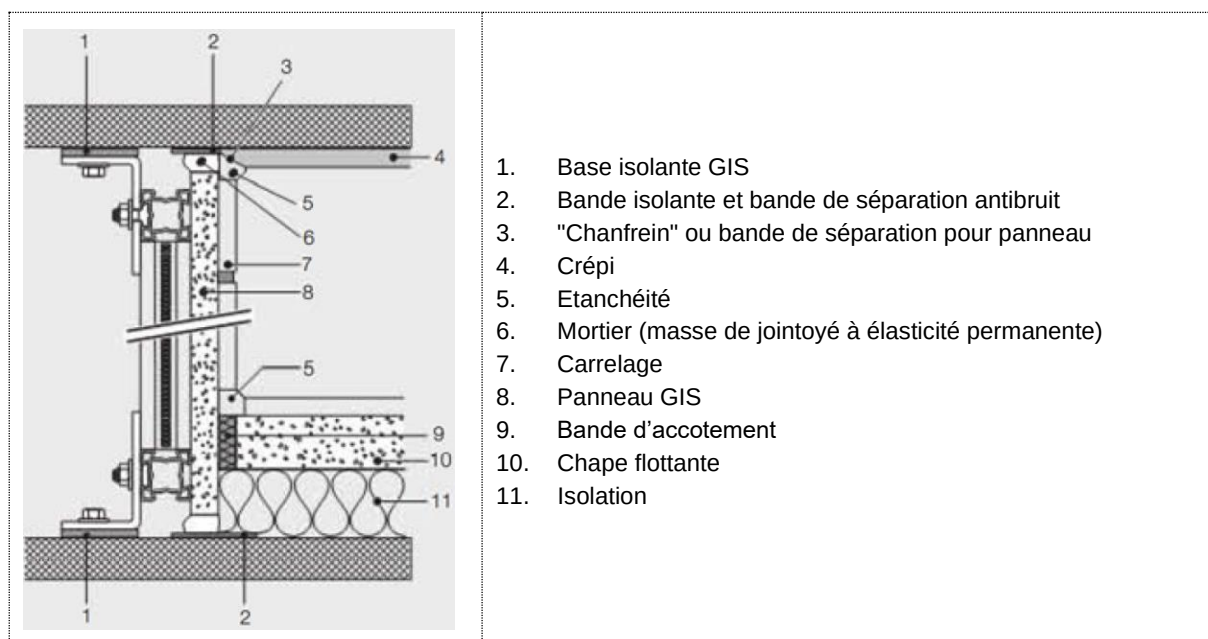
Détail du raccord de la cloison légère avec plancher et plafond (Source Geberit).
